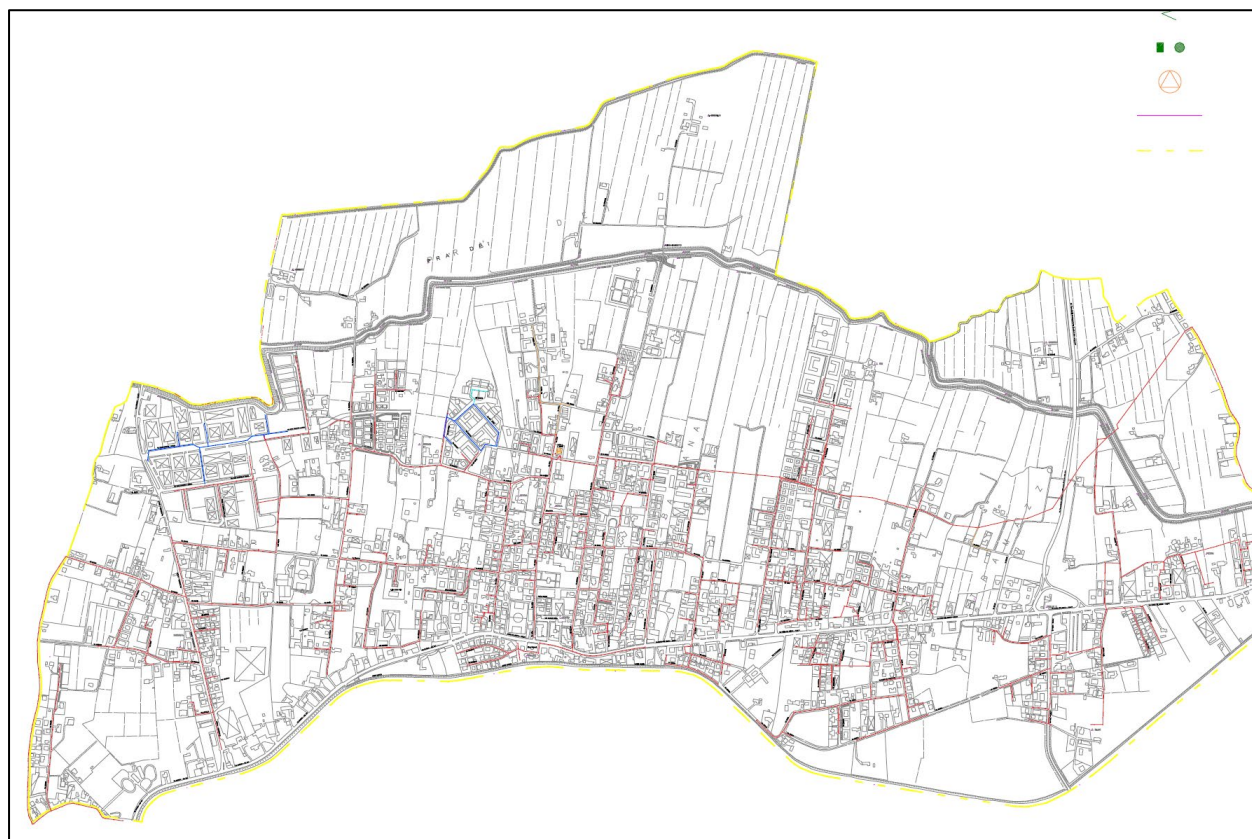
Planimetria della rete fognaria – Fonte VERITAS 2018
